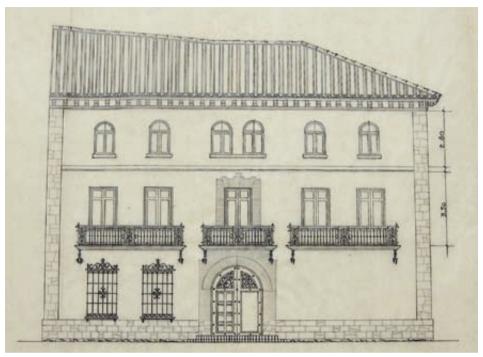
Fachada principal del proyecto de ayuntamiento de Aguilón, 1930 (A.D.P.Z.).
